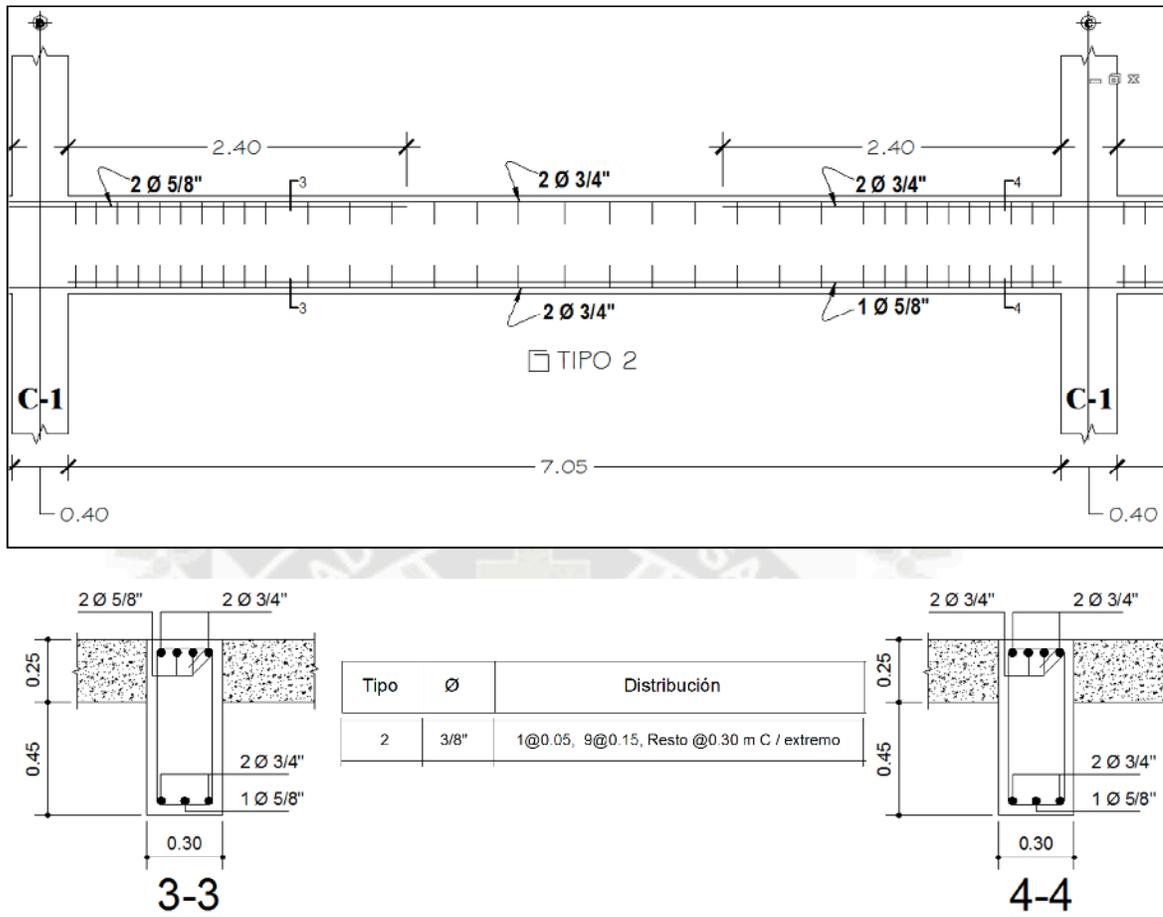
Diseño Final de Tramo Seleccionada de la Viga V-002 - Sótano.
